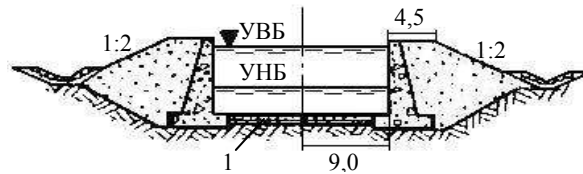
Камера судоходного шлюза с отдельно стоящими стенами и водопроницаемым дном:
